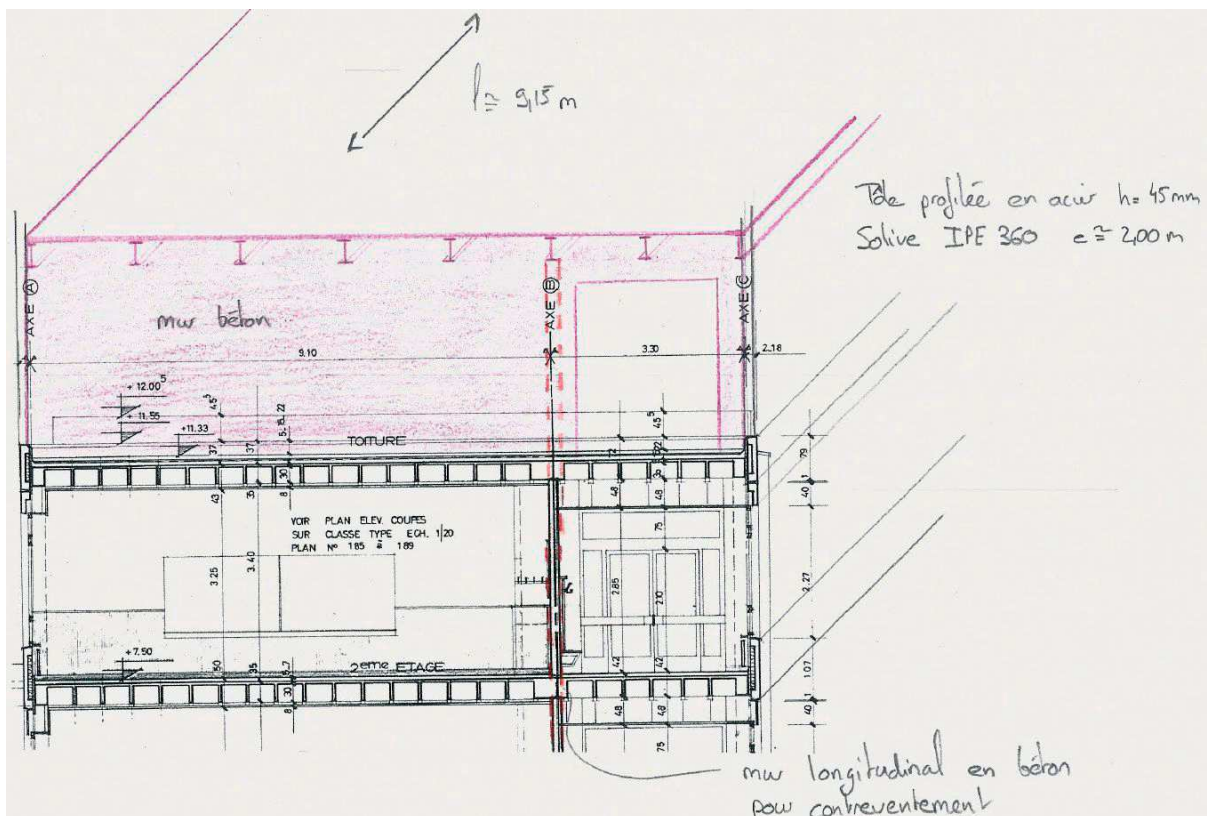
Proposition pour la surélévation des ailes Est et Ouest en construction métallique
